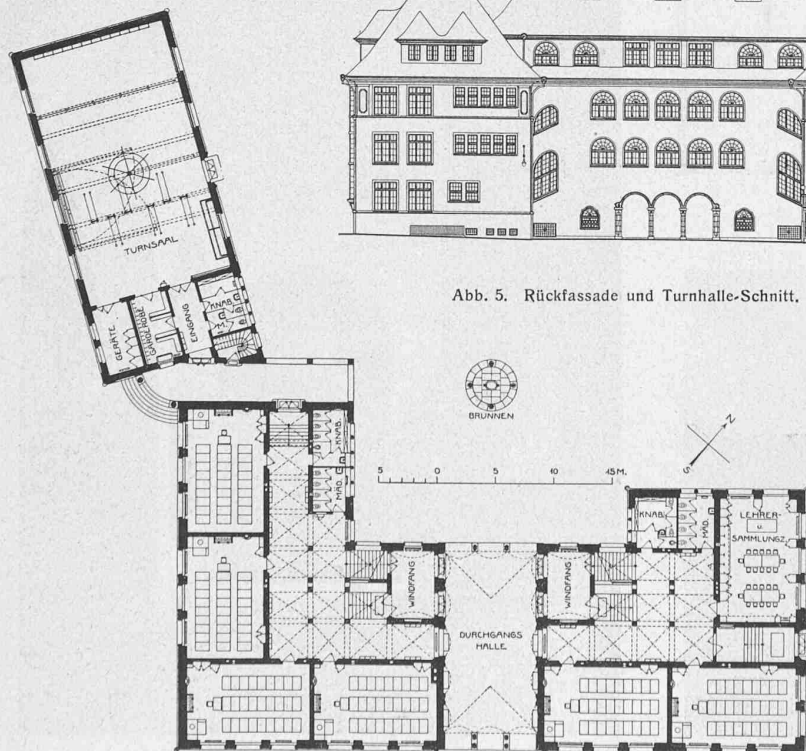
Erdgeschoss-Grundriss des Letten-Schulhauses samt Turnhalle. — 1:600.
